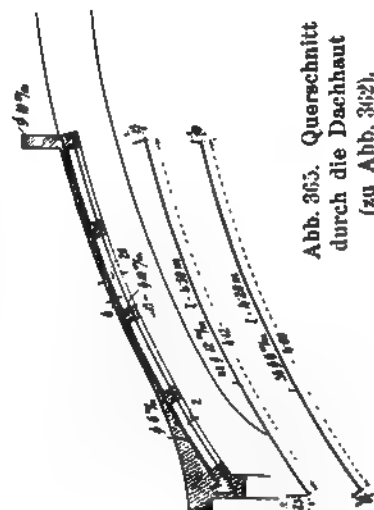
Querschnitt durch die Dachhaut (zu Abb. 362).
